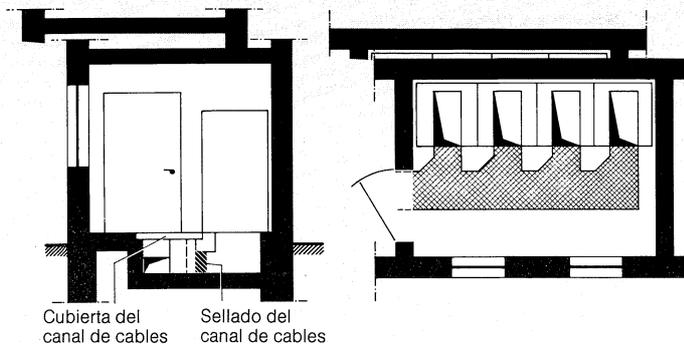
/34 Ejemplo de un canal de cables cubierto en una subestación
